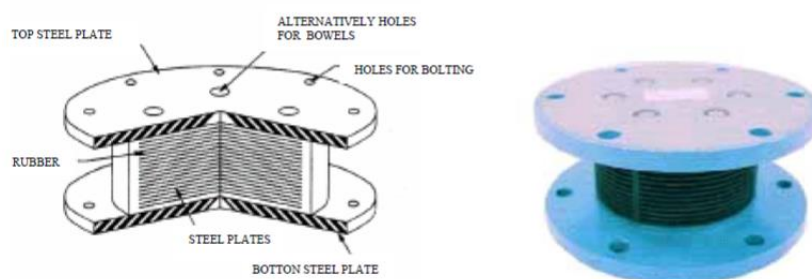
Aislador de goma reforzado con chapas de acero (RB).
